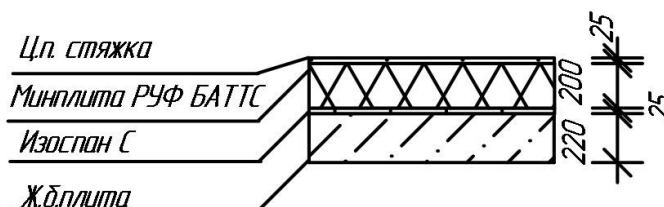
Эскиз ограждающей конструкции перекрытия
